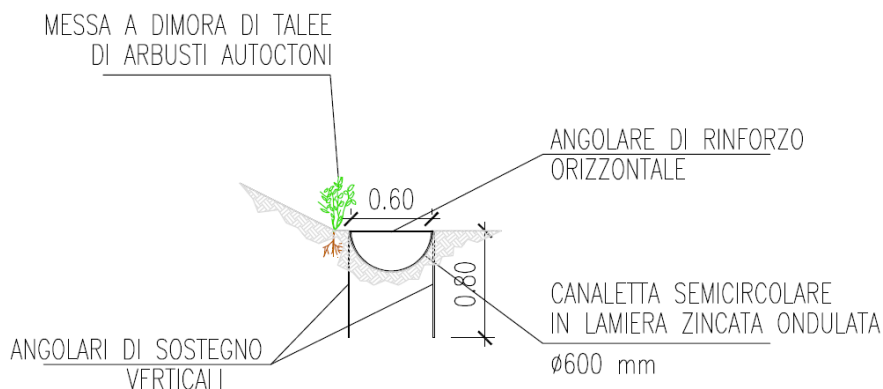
CANALETTA METALLICA A PROTEZIONE DELLE VIABILITÀ DI CANTIERE
